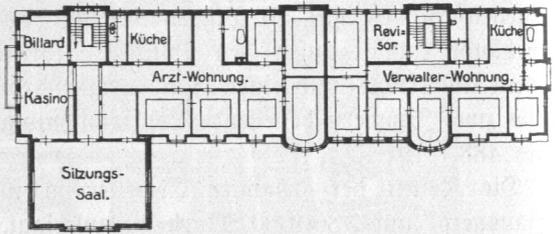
Irrenanstalt Friedrichsberg, Verwaltungsgebäude, Obergeschoss, Grundriß.
